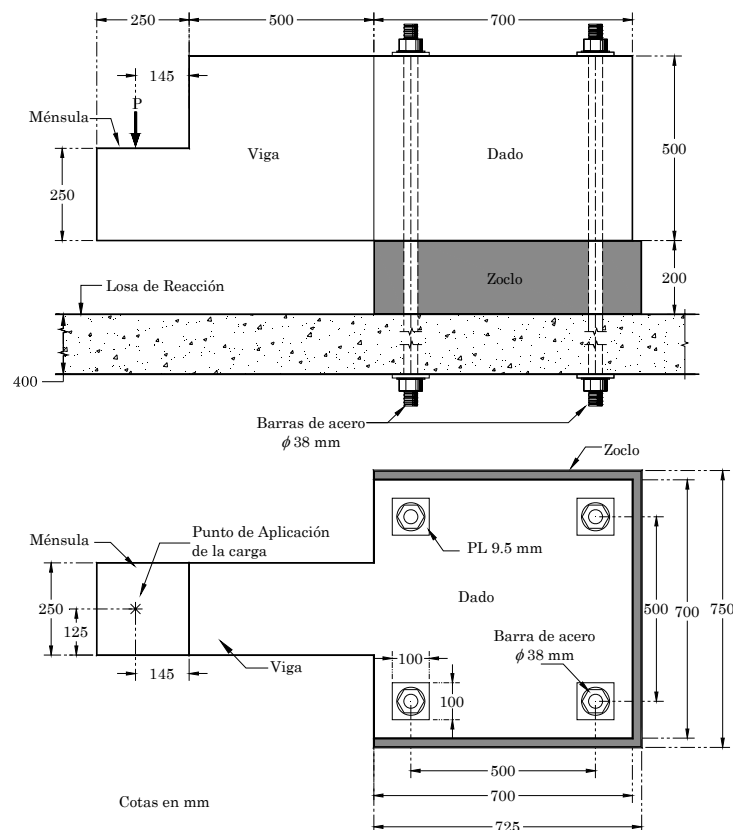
Dimensiones del espécimen de concreto reforzado
